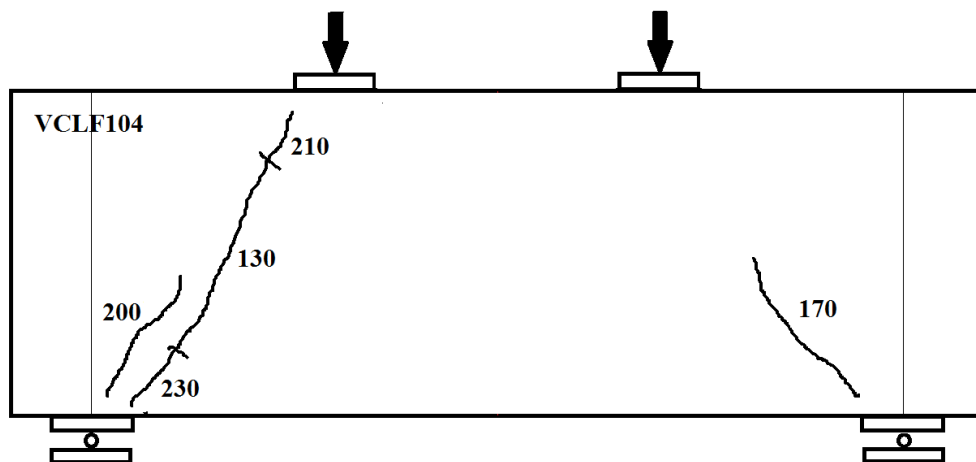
Esquema de fissuração da viga VCLF104.
